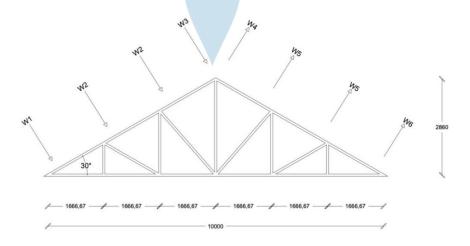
Beban Kuda-kuda Bangunann Edukasi B
